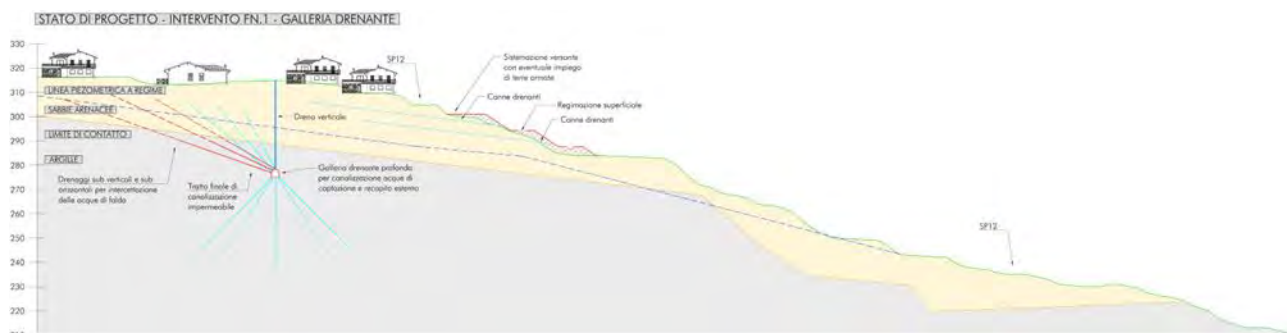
Sezione tipologica del versante in frana con galleria drenante profonda nelle argille.
